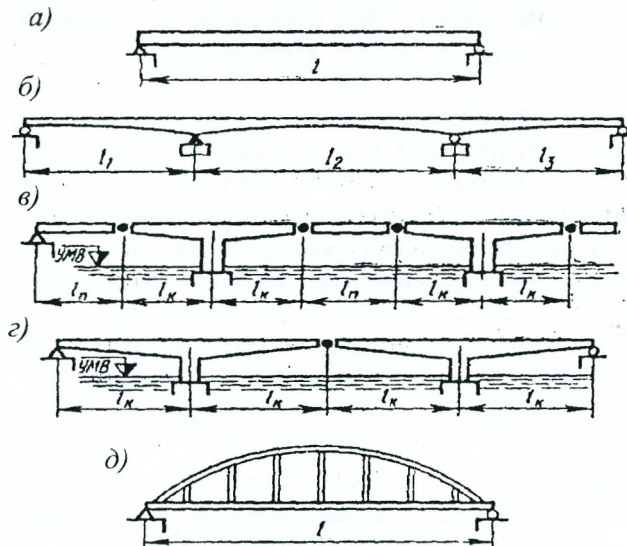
Железобетонные пролетные строения мостов: а – балочное разрезное; б – балочное неразрезное; в – рамно-подвесное; г – рамно-консольное; д – арочное с затяжкой
